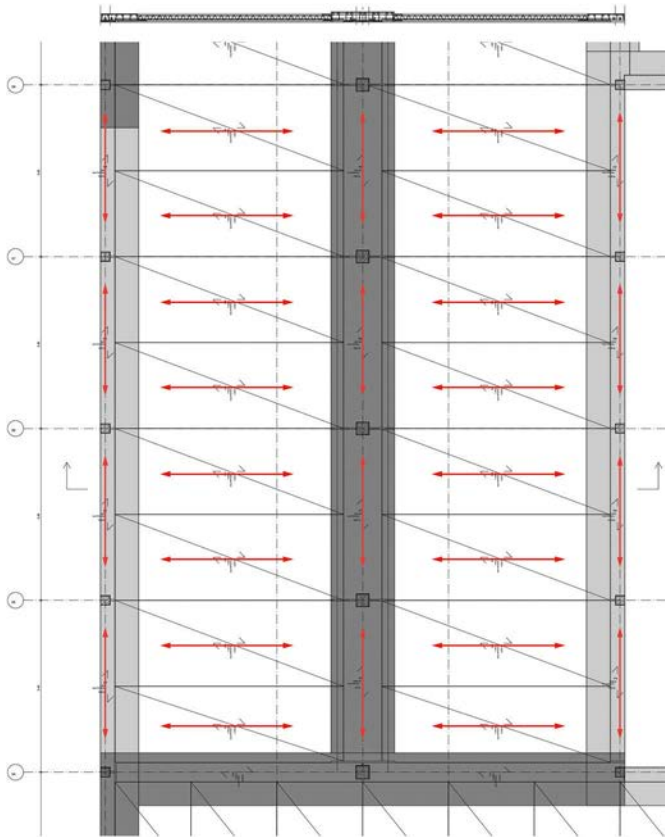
Statisches System für den Deckengrundriss für Rhenania mit einachsig gespannten Deckenplatten und vorgespannten Gurtstreifen
